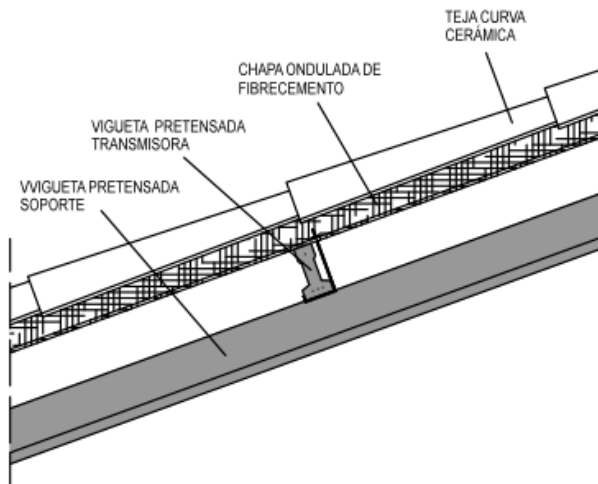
Sección cubierta zona pública existente en la vivienda. Fuente propia.
